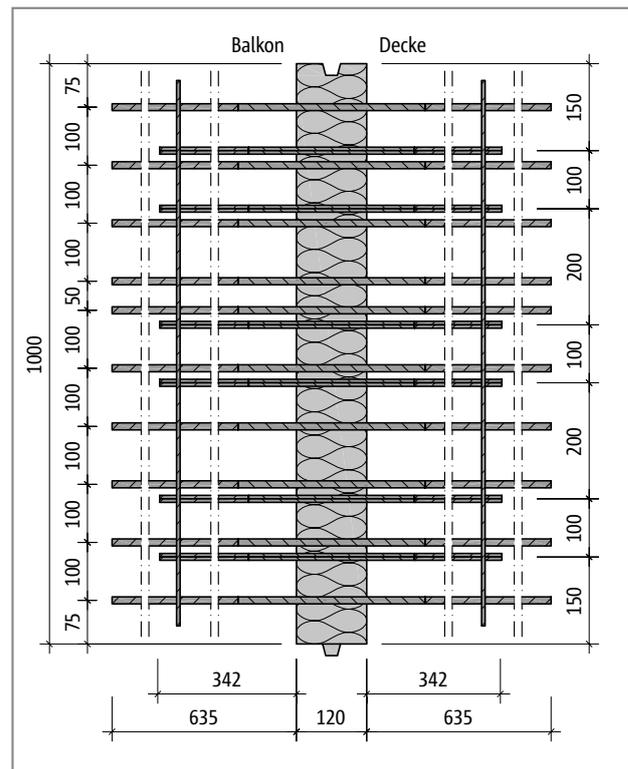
Schöck Isokorb® Typ DXT70-VV6: Grundriss
